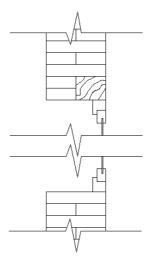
Encuentro de muro con ventana, caravista. Fuente: Edición propia
